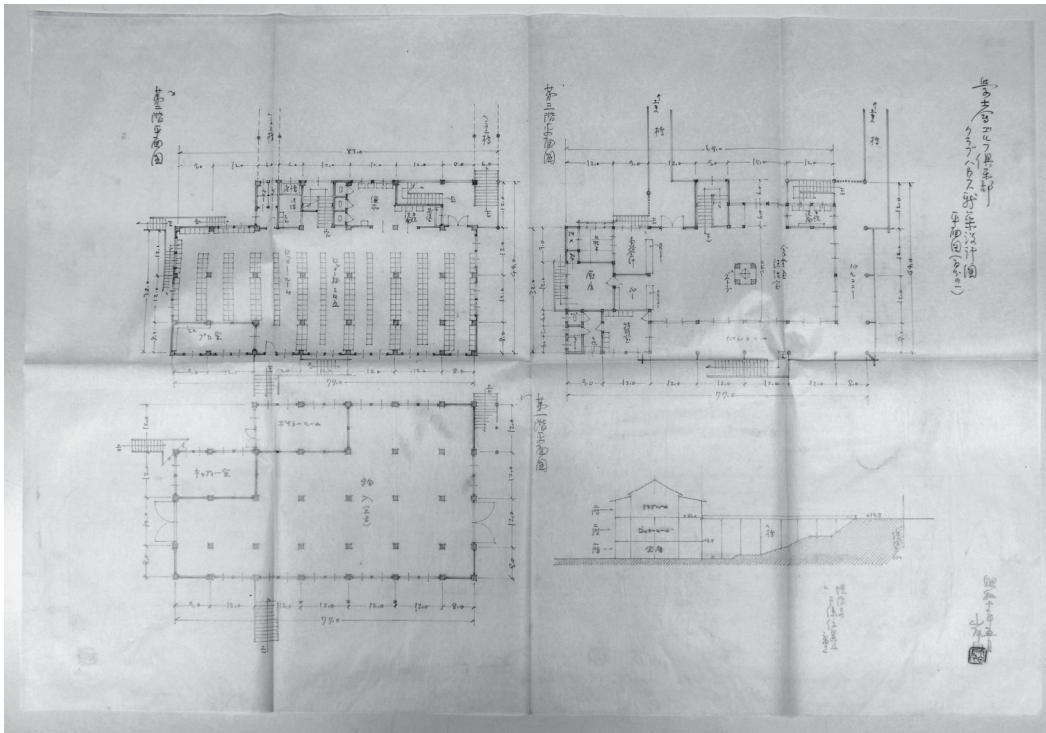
「学生会ゴルフ倶楽部」各階平面図（金沢工業大学蔵）
